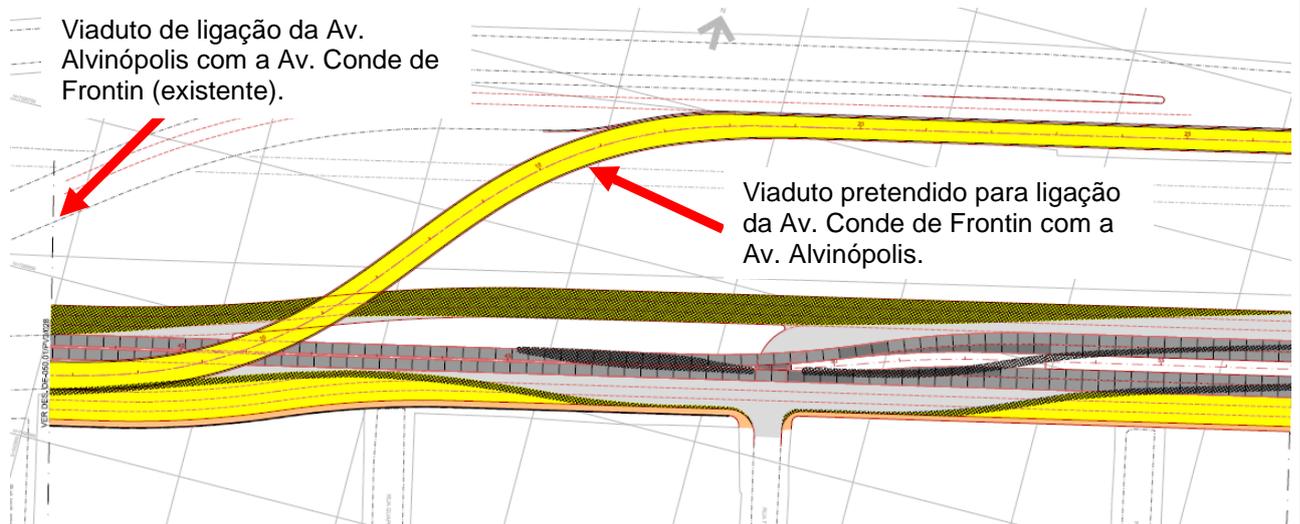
Vista OAE – Viaduto Penha que será implantado para ligação da Av. Conde de Frontin com a Av. Alvinópolis.
